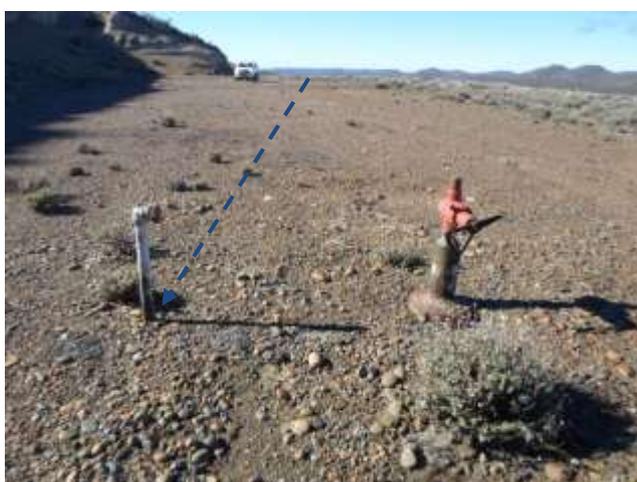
Emplazamiento de línea de inyección por picada parcialmente revegetada. Al fondo se observa talud de locación de Pozo G-567. Foto en dirección E.
